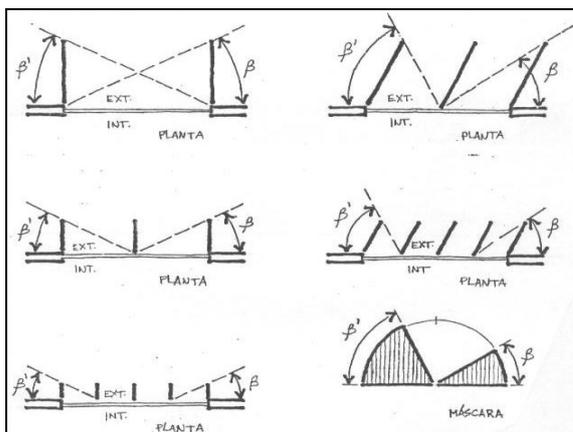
vista em planta *brise* vertical (FERNANDES, 1994)
